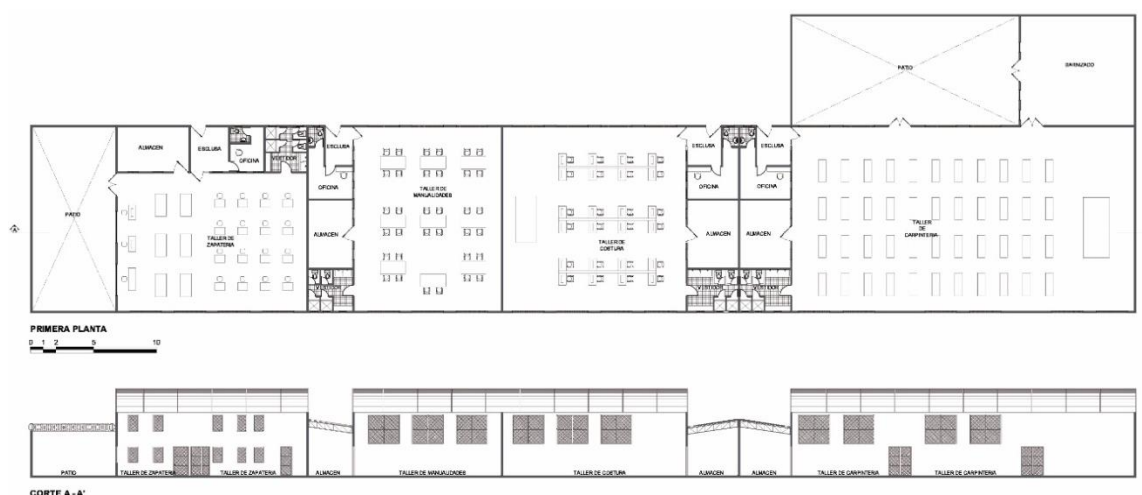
Plantas y corte del CETPRO y CEBA de la zona A
